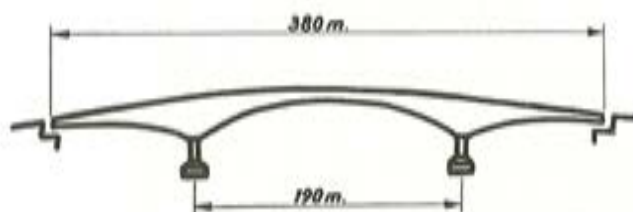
Puente en voladizo sobre el río Higuamo (República Dominicana).
